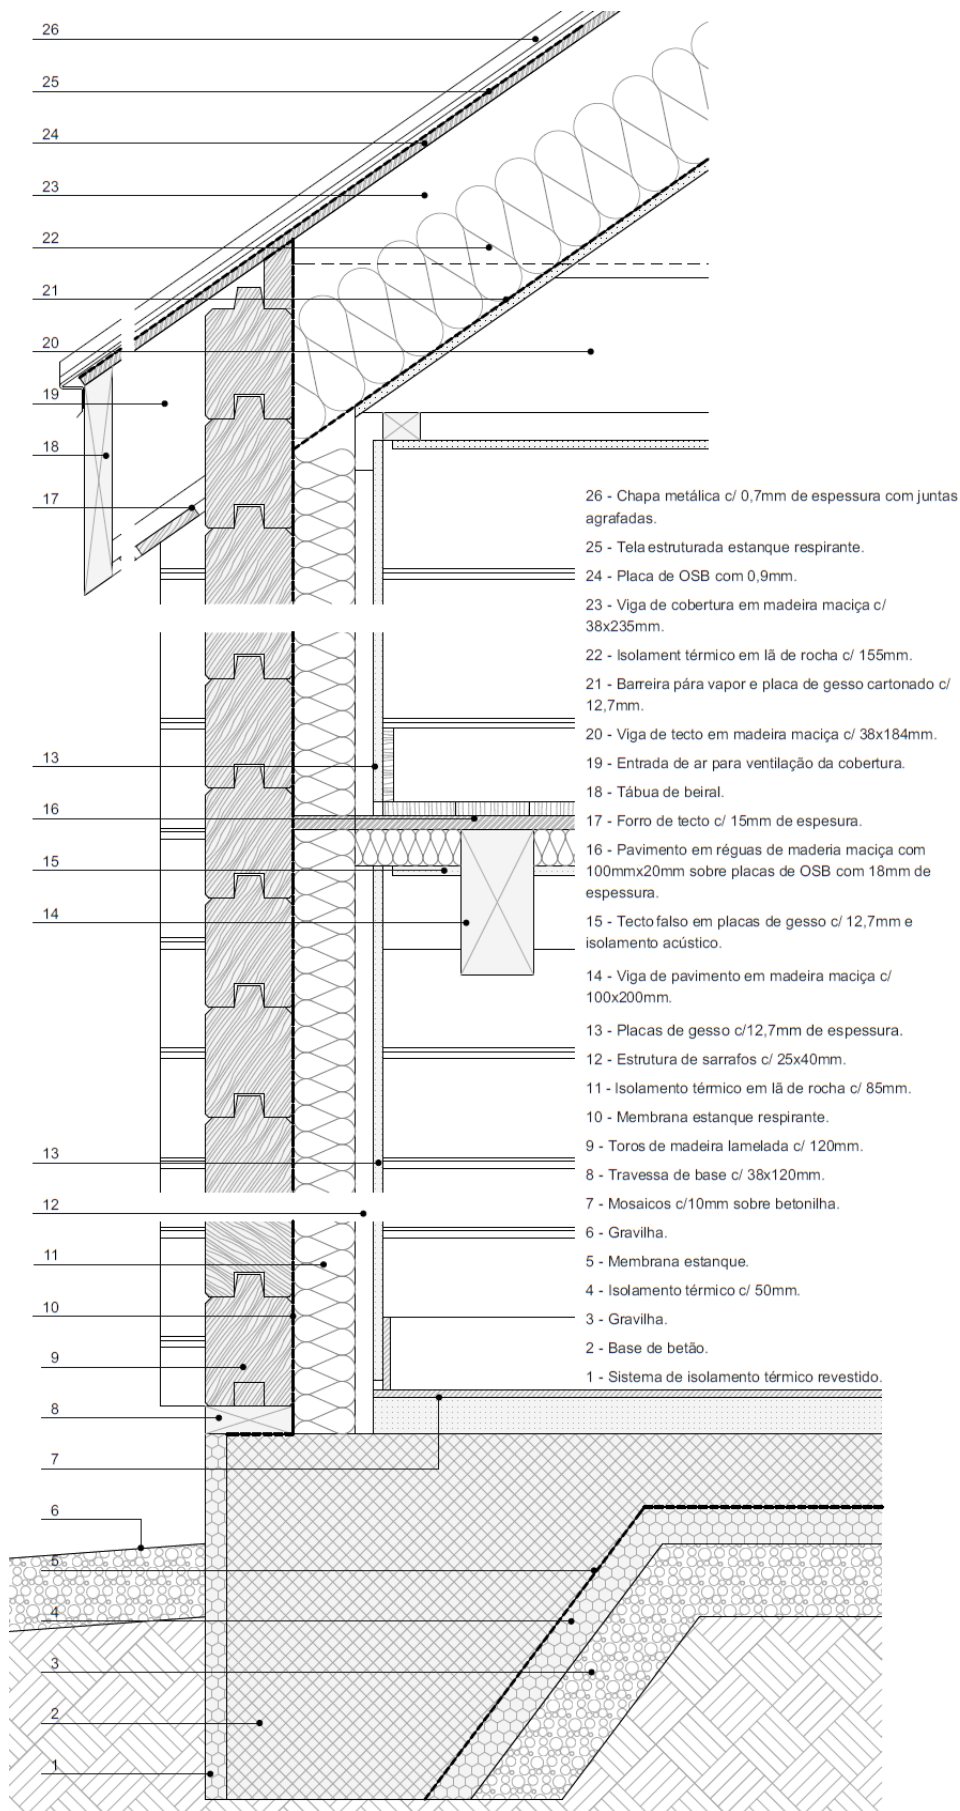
Corte construtivo pela fachada da solução de paredes pesadas de toros.
